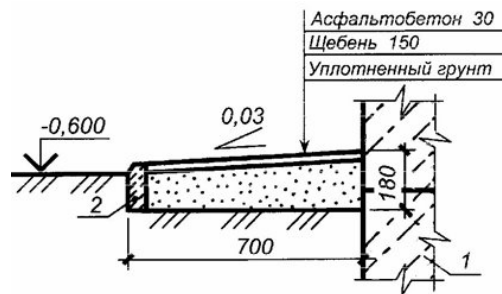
Конструкция отмостки: 1 – фундаментный стеновой блок; 2 – бетонный бордюрный камень размерами 150×60 мм
